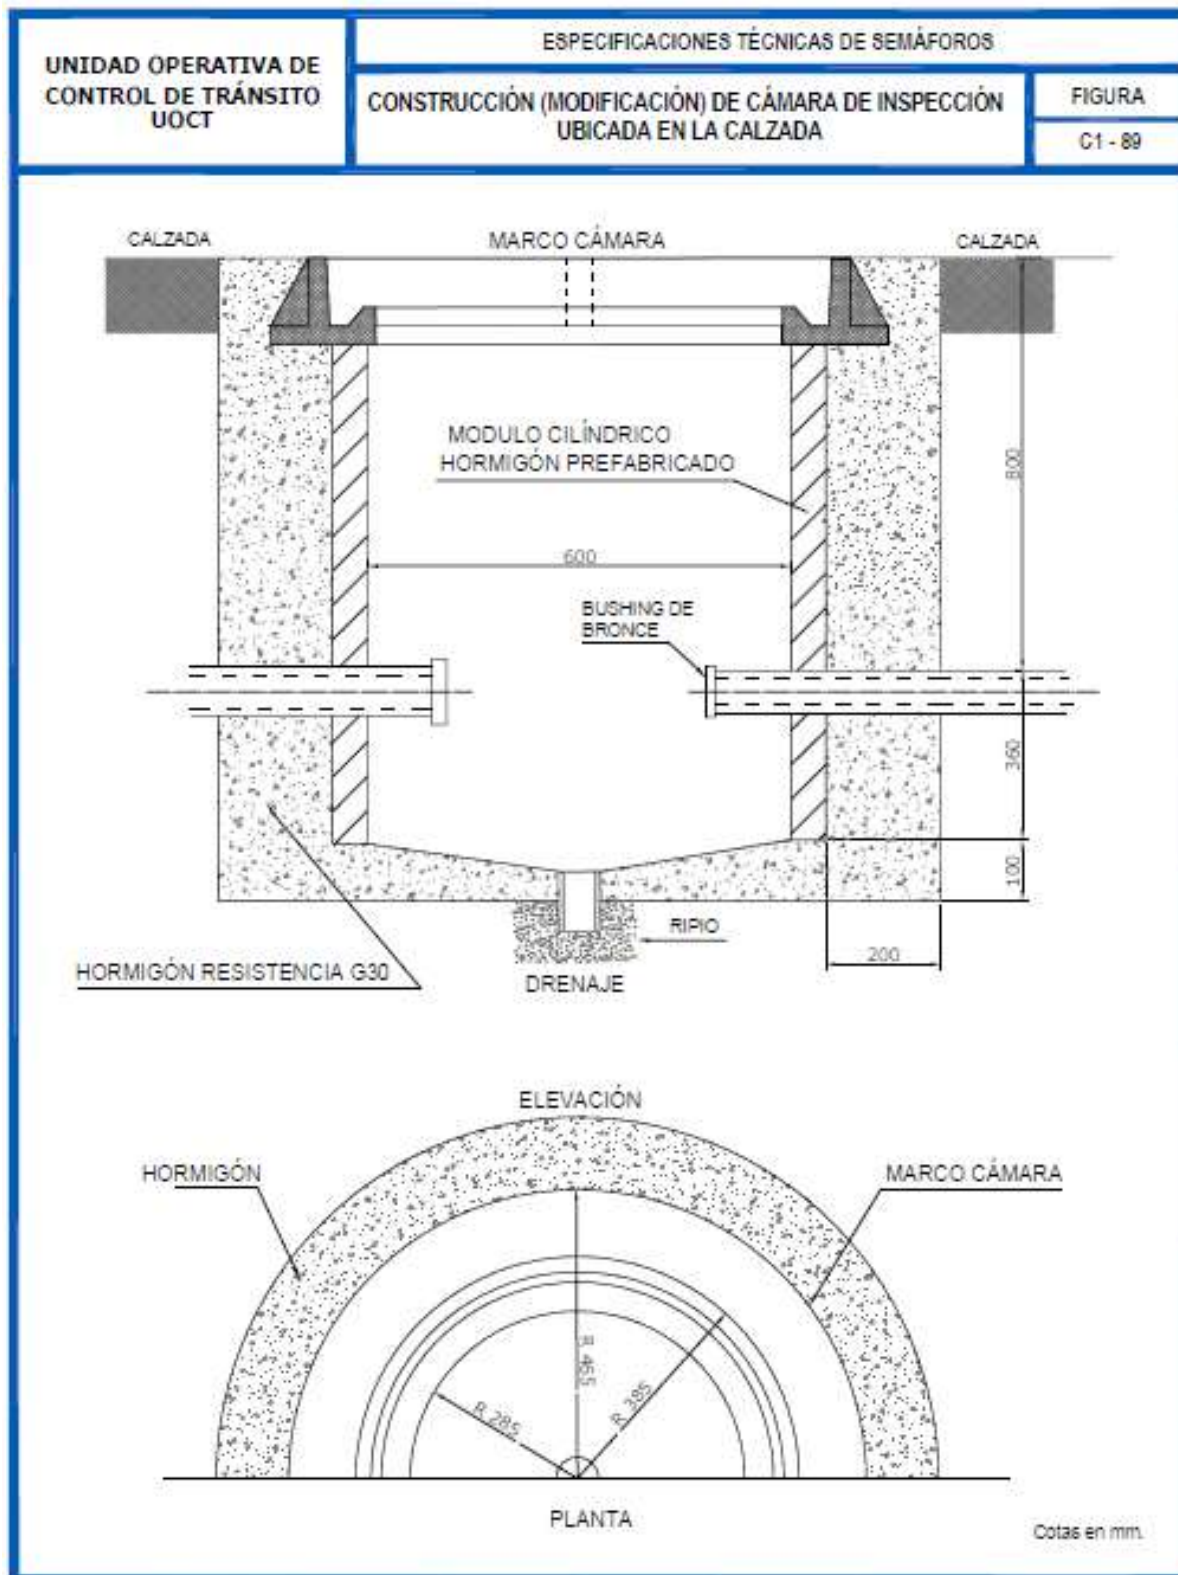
89 Construcción (Modificación) Cámara de Inspección Ubicada en la Calzada
